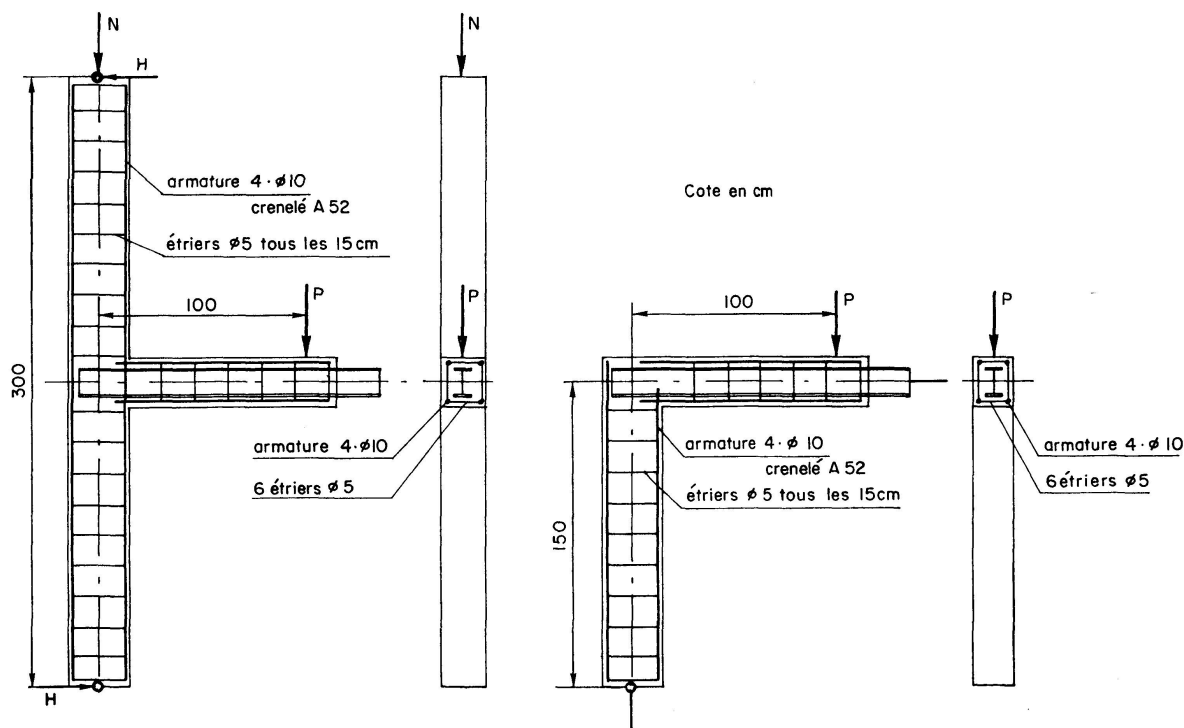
Schema d'essai. Armatures des nœuds essayés. Barres d'encastrement non figurées.
